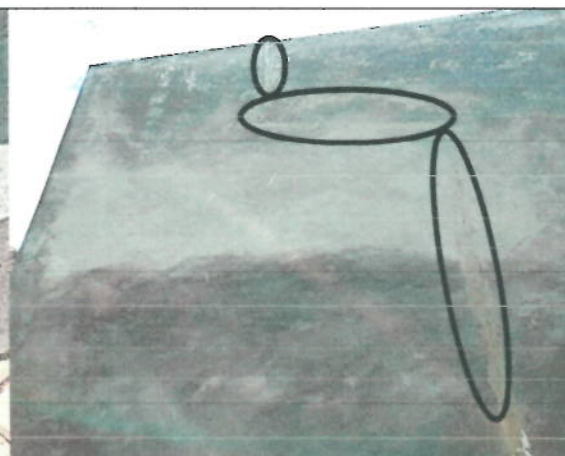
Se halló fisuras verticales en la parte superior del muro de contención (corona) ubicada en la parte posterior del campo de básquet del estadio.
